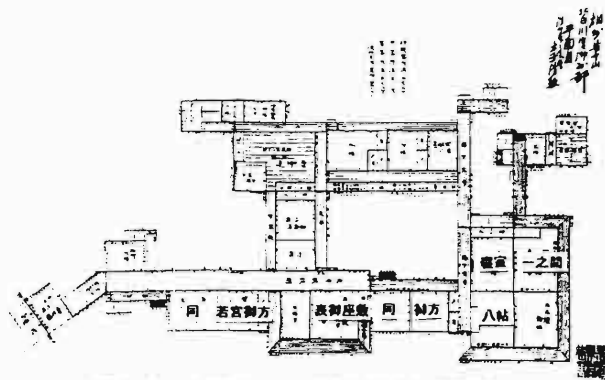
北白川宮葉山別邸 (A 棟) 平面図
